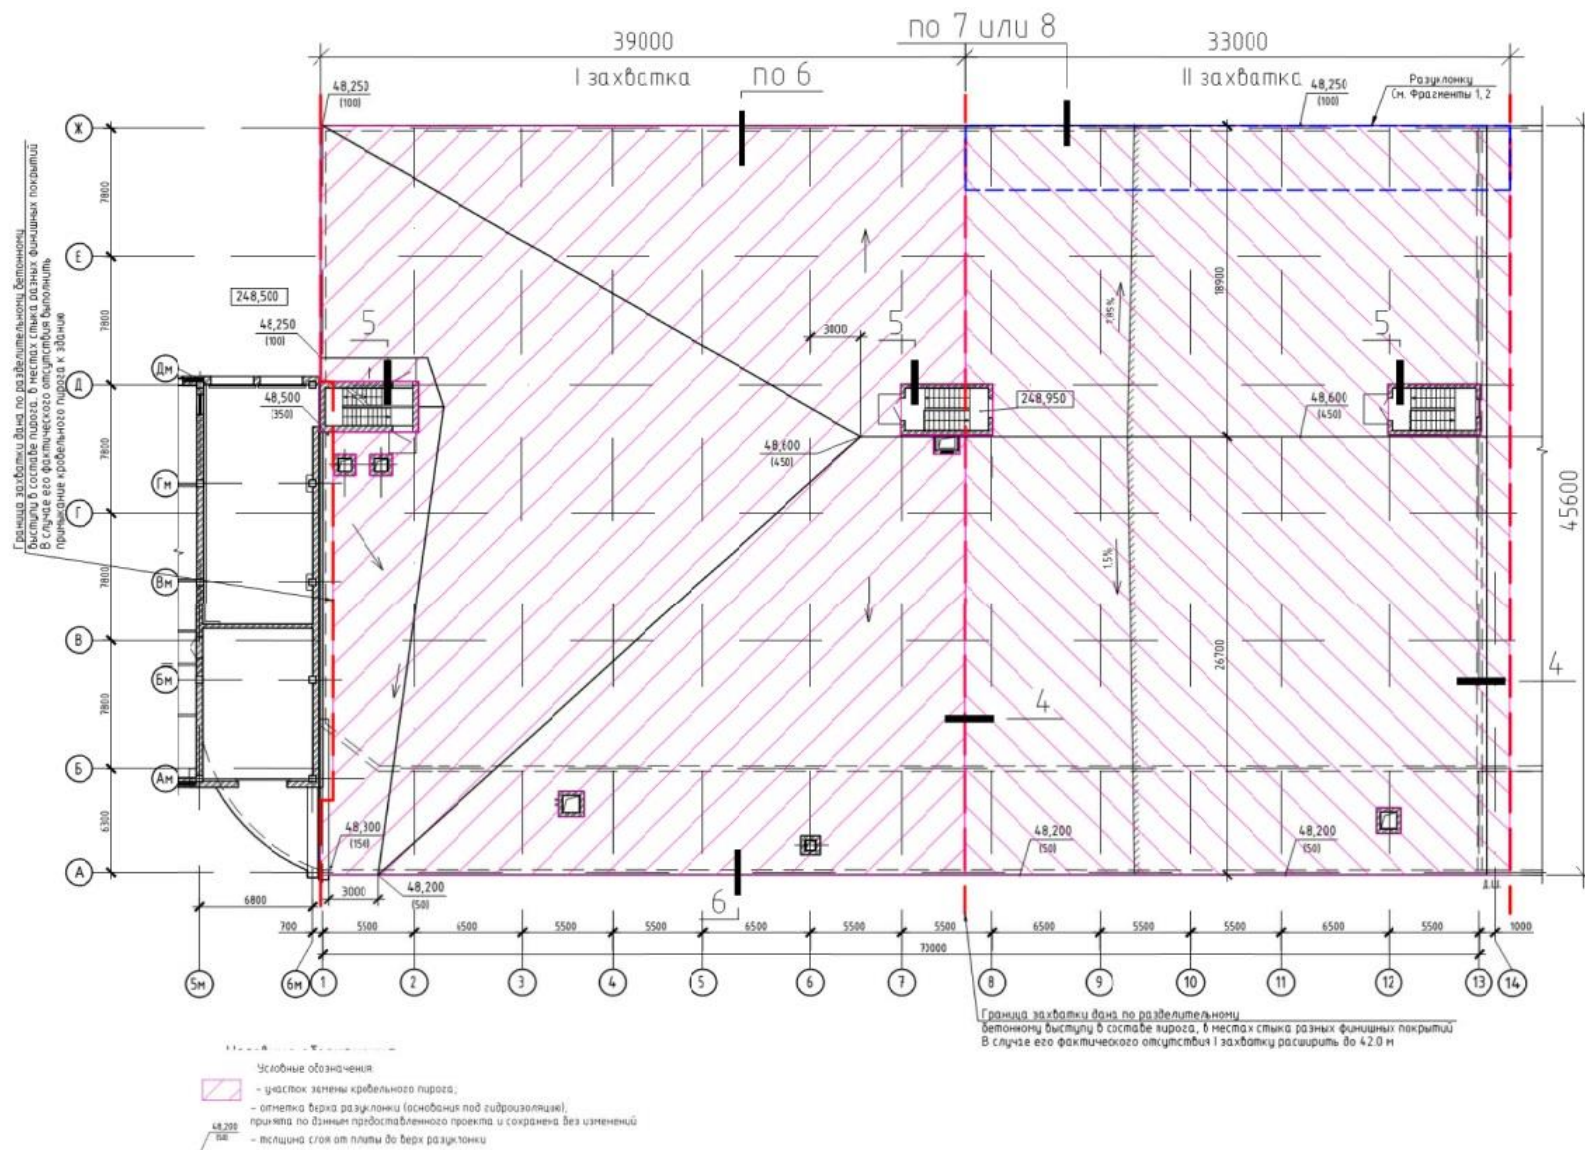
Вариант №3. Схема участков замены кровли.
